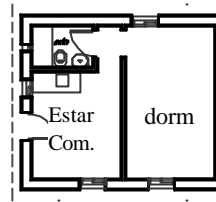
Tipología de vivienda Barrio Talca, planta y modelo 3D
